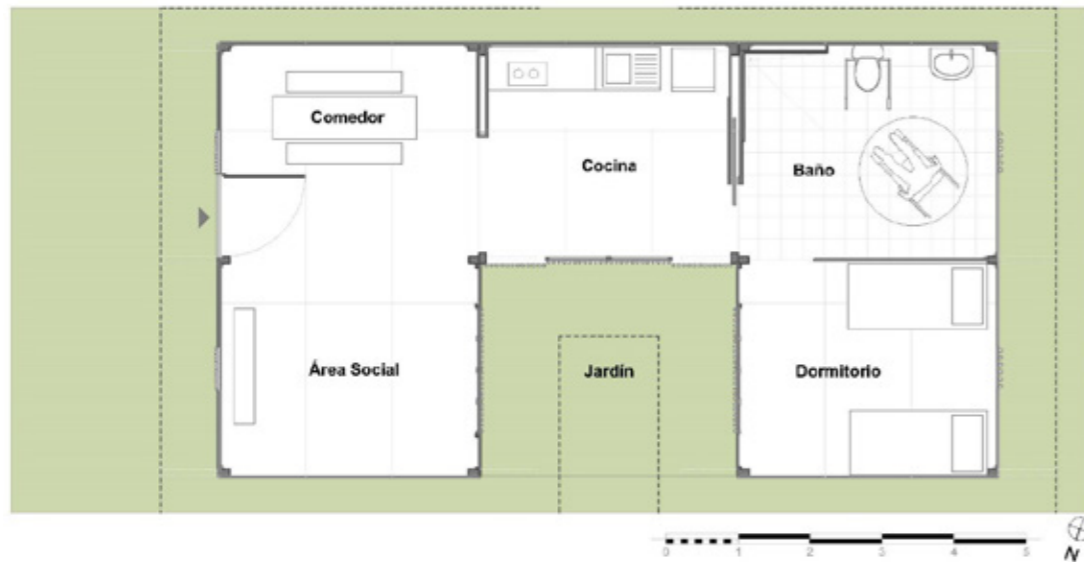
Planta general de la "Casa Gloria". Monte Sinahí, Guayaquil, Ecuador. Fuente: Propia.
